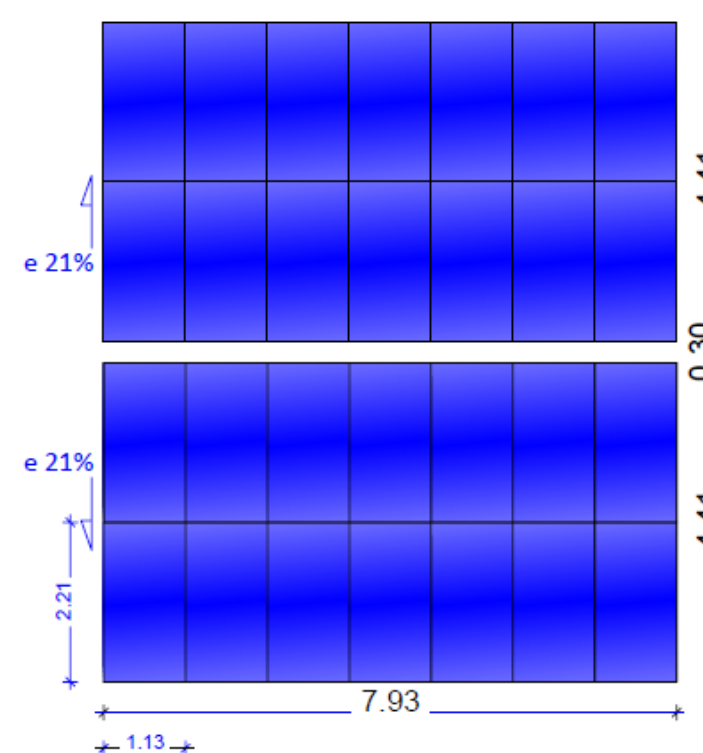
Plan de toiture des tables (Source : Permis de construire du projet, mai 2022)
